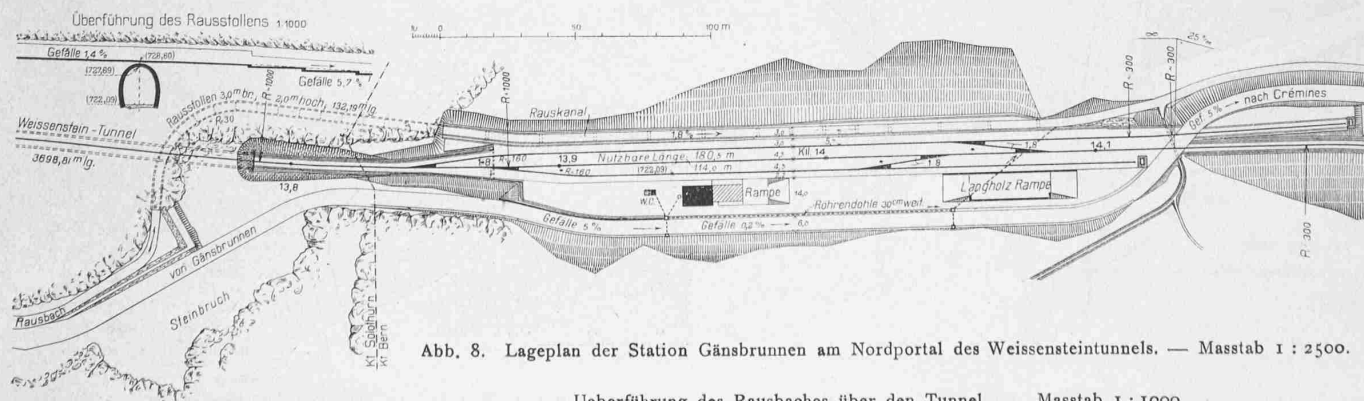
Lageplan der Station Gännsbrunnen am Nordportal des Weissensteintunnels. — Masstab 1:2500.
